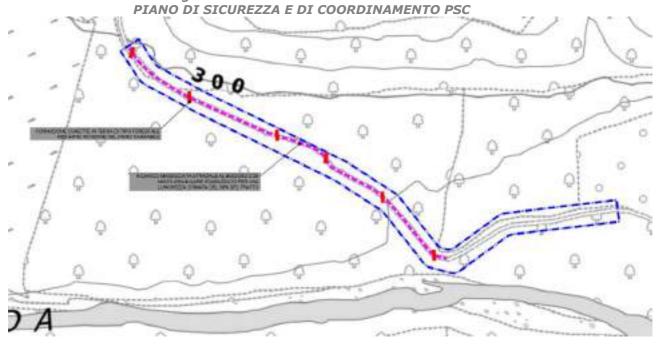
Planimetria di progetto. (rappresentazione non in scala)
